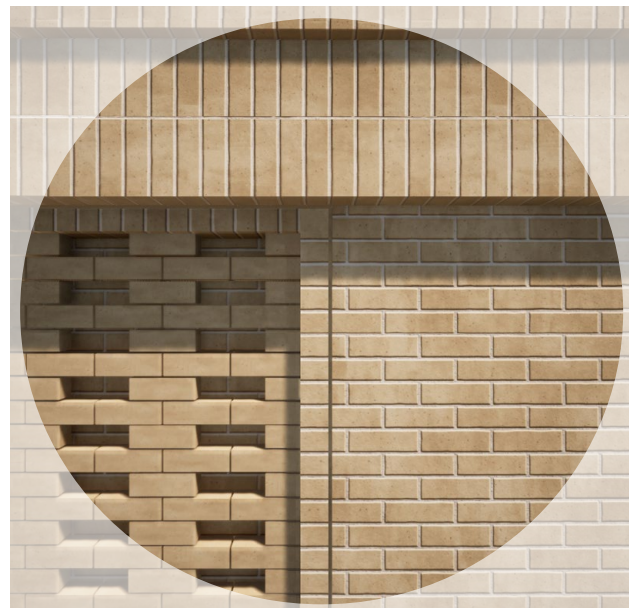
Detalle de Fachada. Fuente: Autoría propia.
